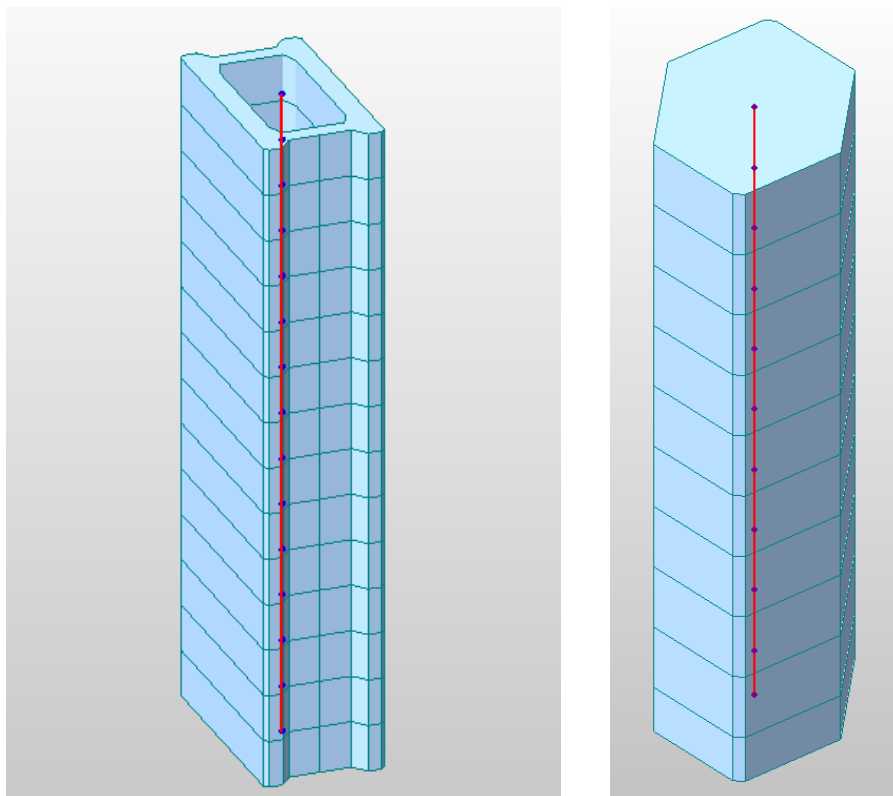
Elemento beam rappresentativo delle pile presenti sul viadotto
